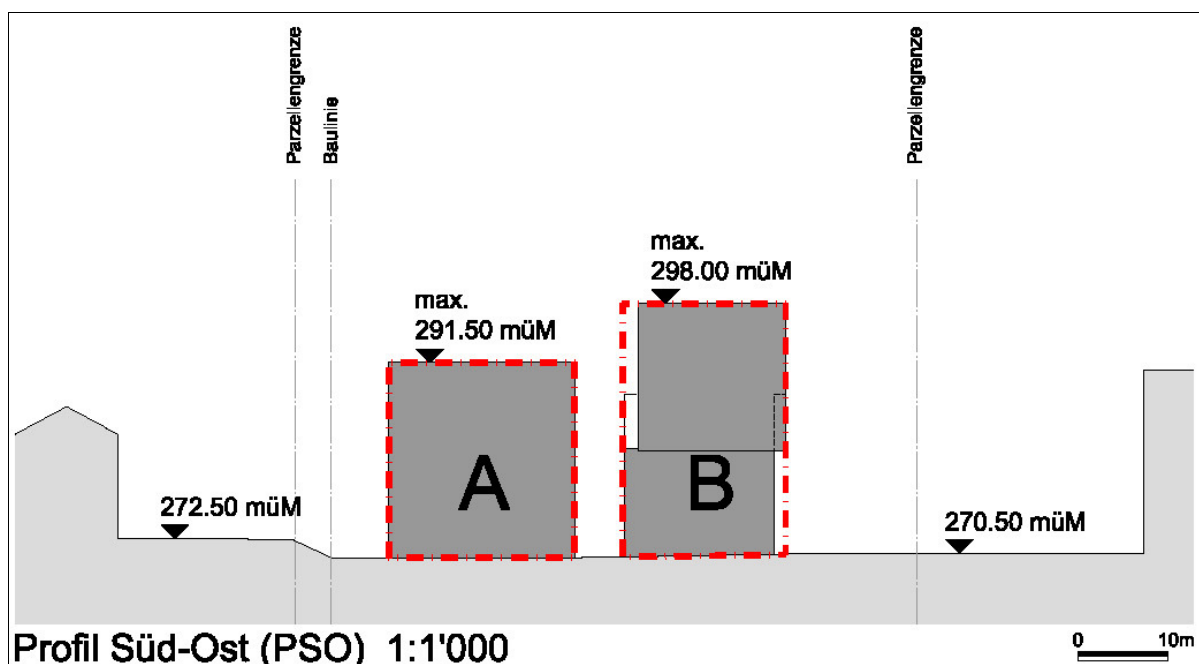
Plan-Nr. 13'191. Bebauungsplan: Profil Süd-Ost (kein Massstab)
